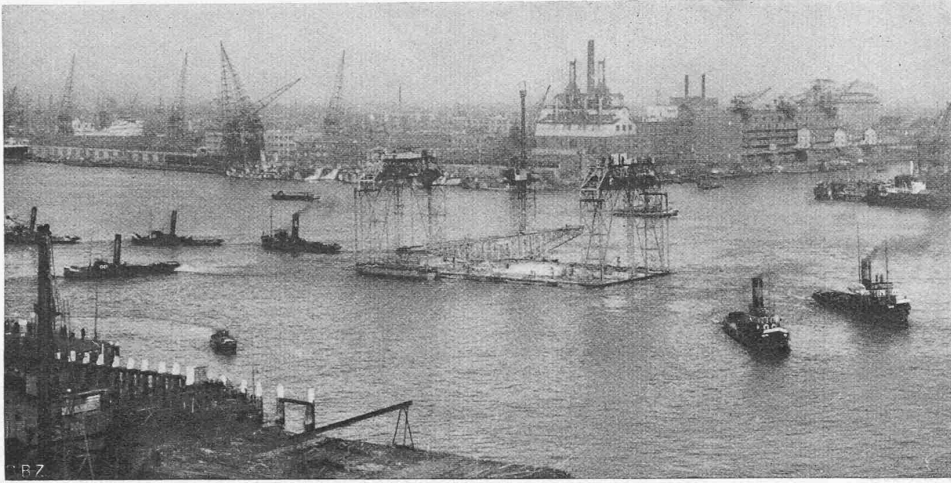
Ein fertiges Tunnelstück, mit Richttürmen und Spülapparat ausgestattet, wird nach der Einbaustelle geschleppt
